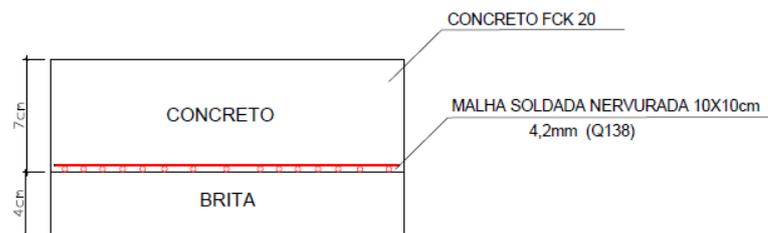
Detalhamento técnico da produção dos pisos em concreto.
